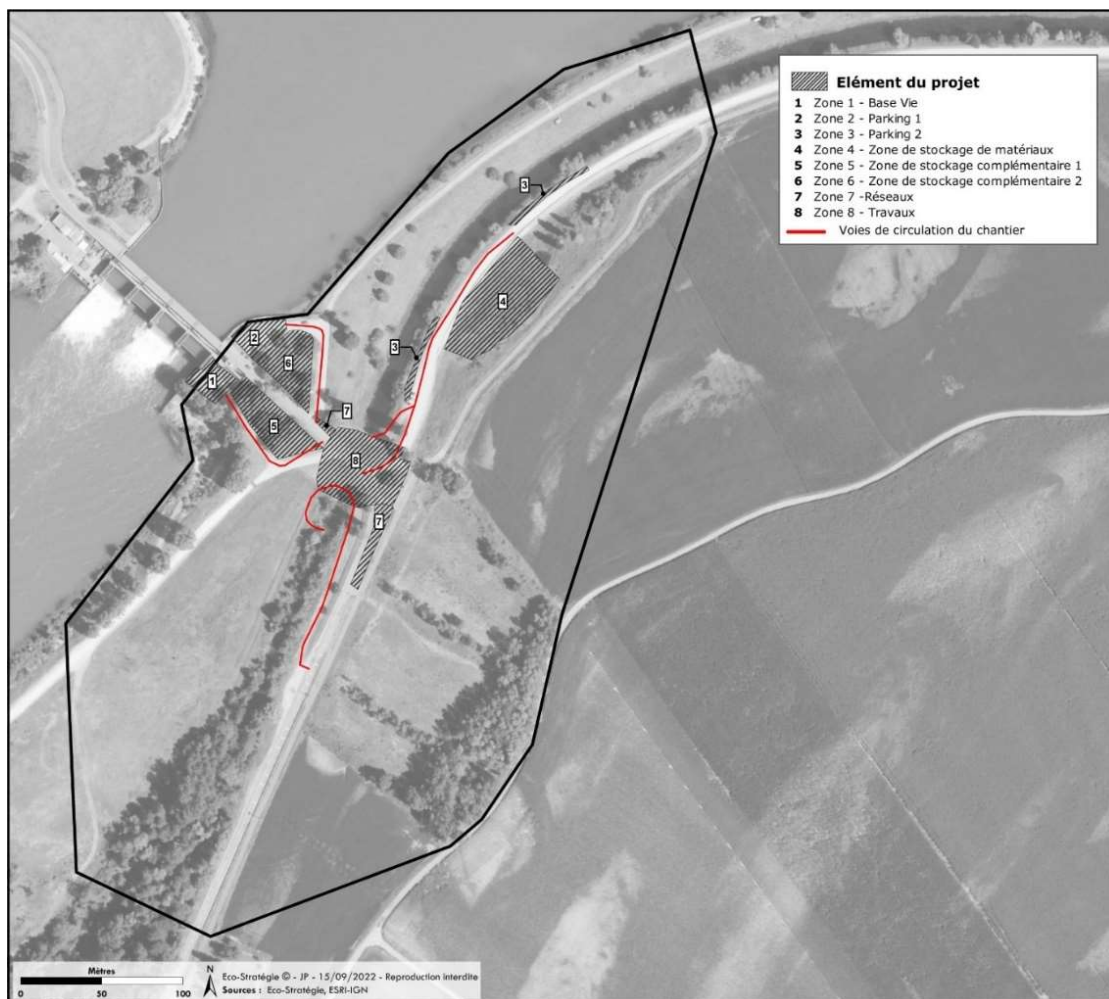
Plan de chantier détaillé – Emprise travaux.
